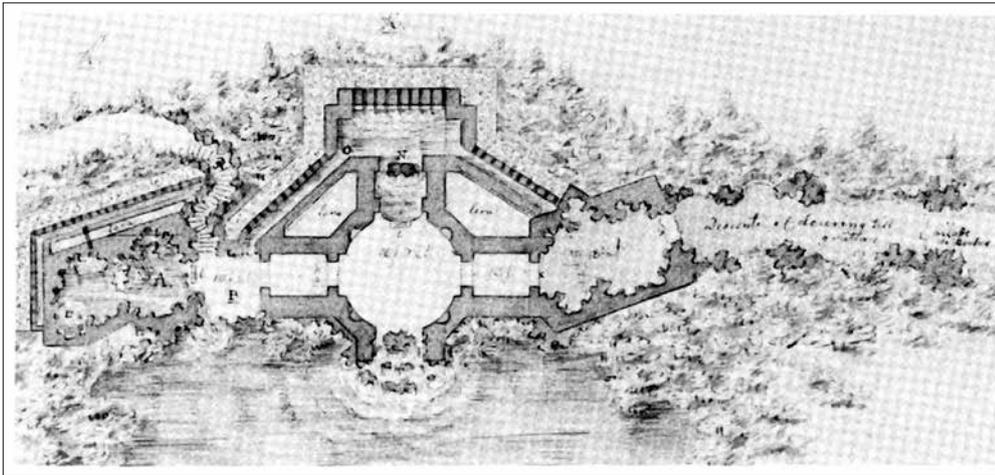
Grundriss der Grotte von Stourhead, Zeichnung von Frederik Magnus Piper um 1775 (aus: Naomi Miller, *Heavenly Caves*, Boston 1982)
